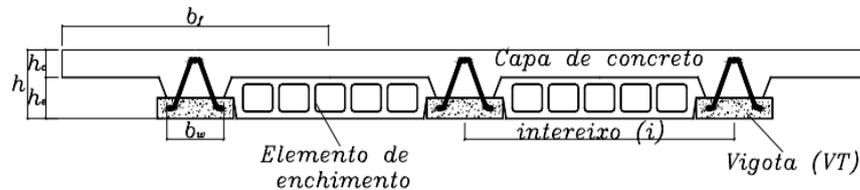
Corte esquemático de uma laje com vigotas do tipo treliça.
